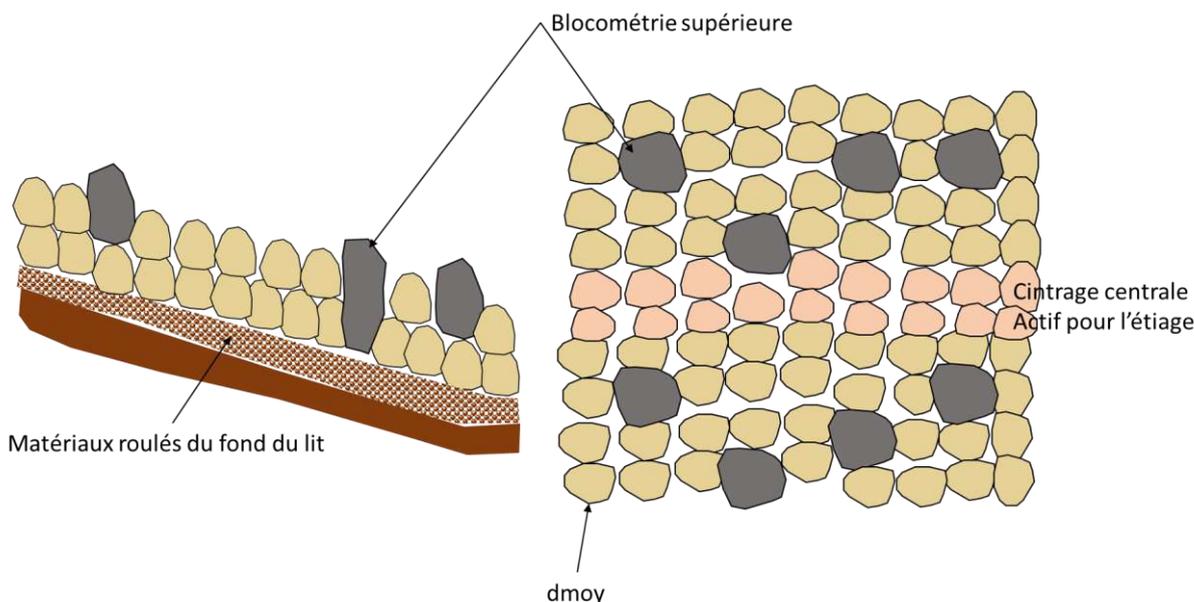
Vue du profil en travers au droit de la rampe (RIV11) et schéma de principe de la rampe attendue.
